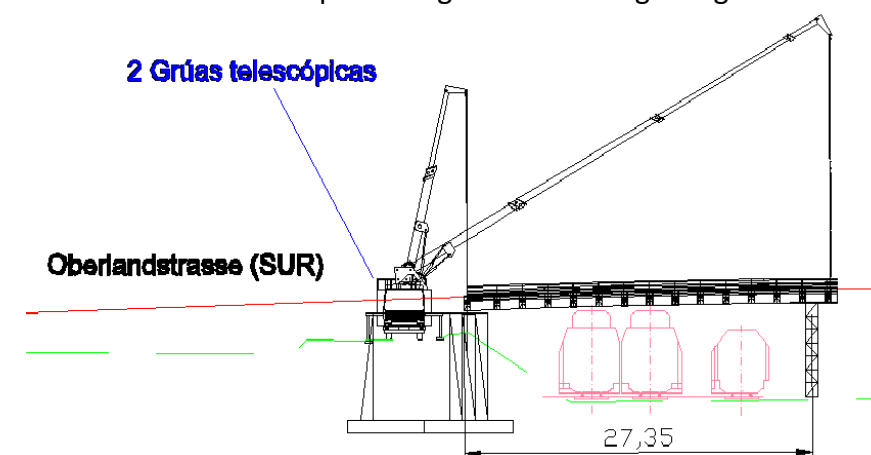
Figura IV: MONTAJE DEL PRIMER TRAMO DE TABLERO (SUR) MEDIANTE GRÚAS TELESCÓPICAS Y APEO INTERMEDIO
